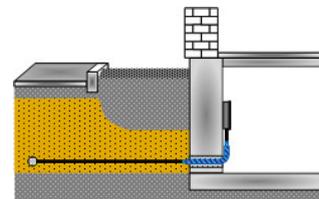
Aufbau des Fundamenterders mit Blitzschutzanlage
